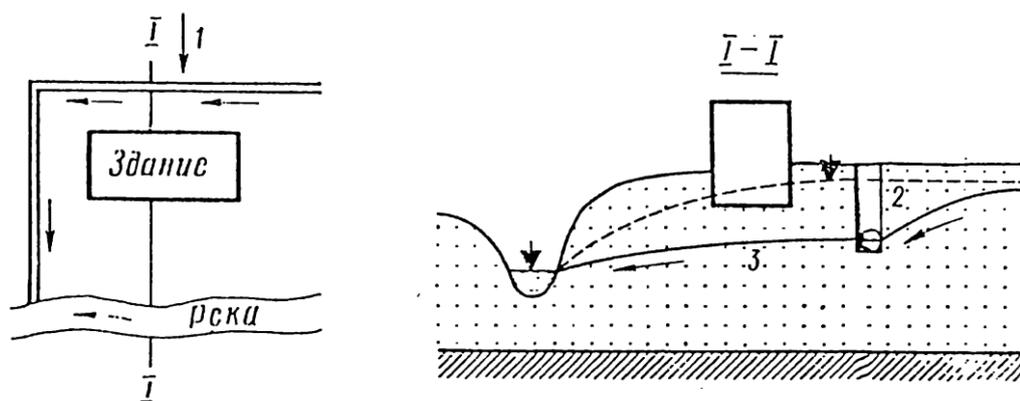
Головной дренаж (план и разрез): 1 — направление потока грунтовых вод; 2 — головная дрена; 5 — сниженный уровень грунтовых вод
